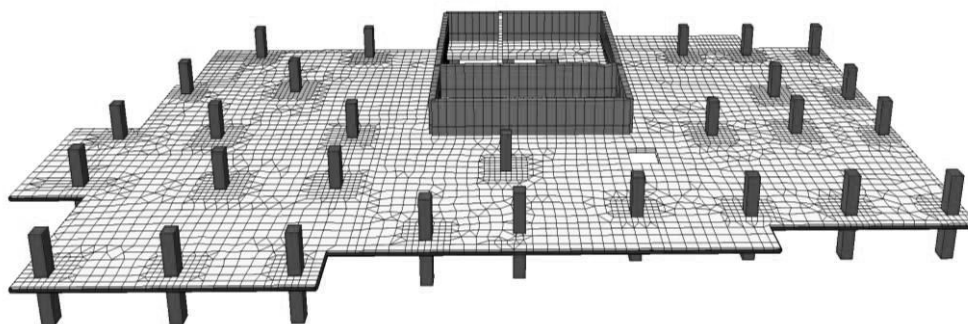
Общий вид расчетной схемы перекрытия типового этажа в ПК Лира-САПР
